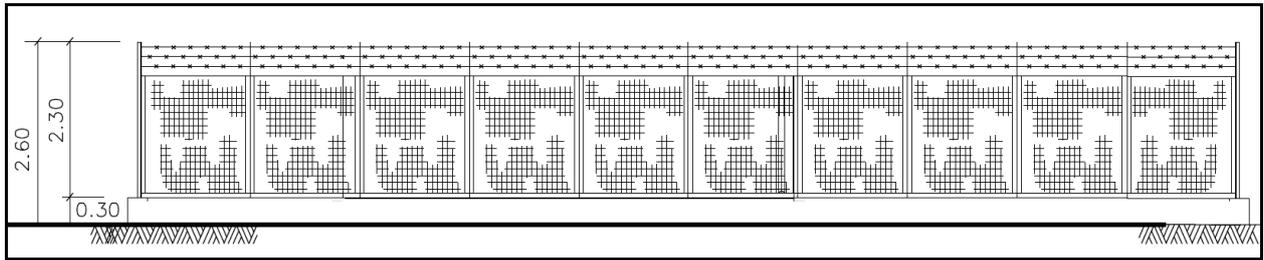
Recinzione proposta con cordolo di fondazione in calcestruzzo
